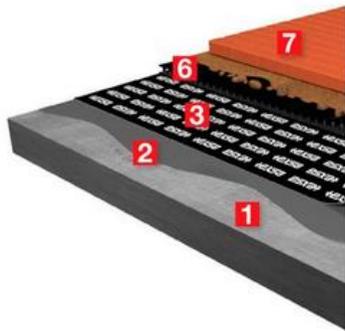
Propuesta de impermeabilización para cubierta caliente invertida.
